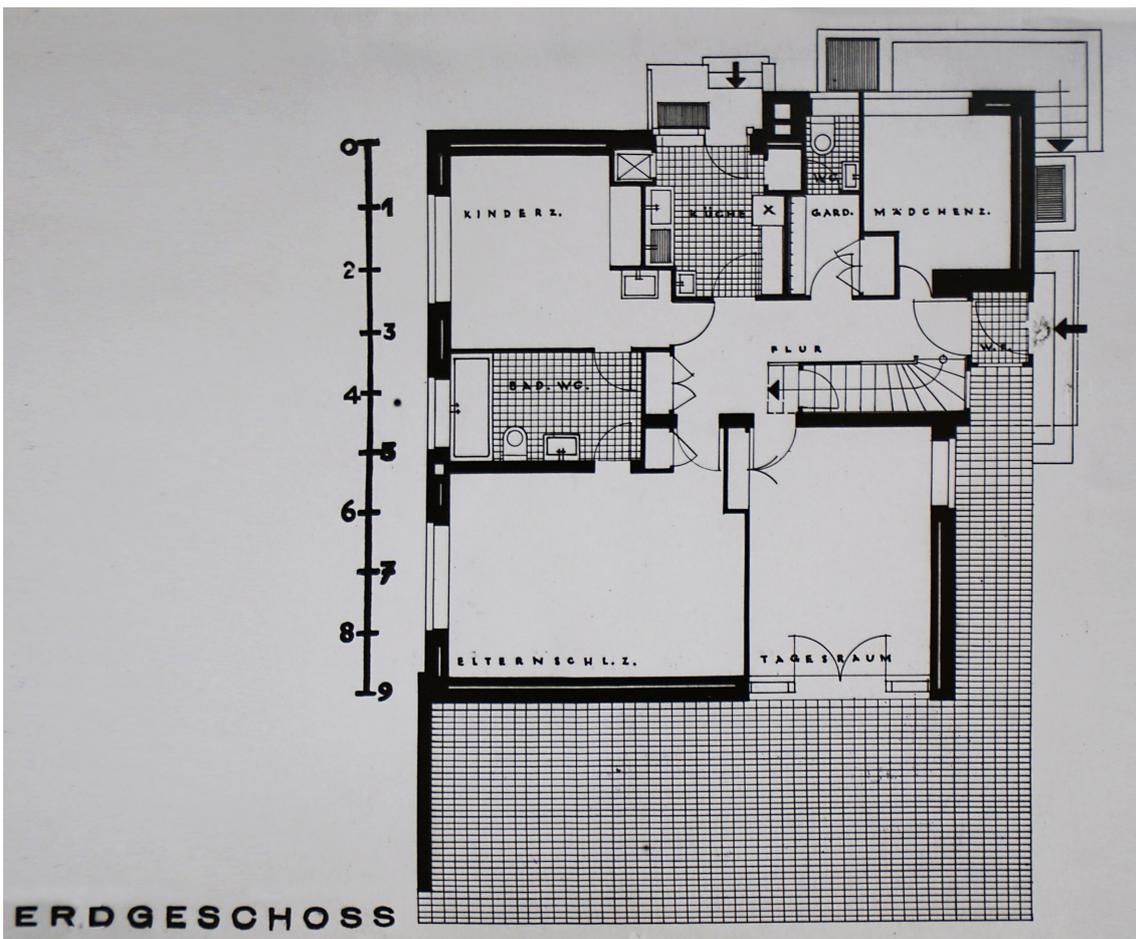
Grundriss Erdgeschoss, Publikationsplan, ohne Datum
